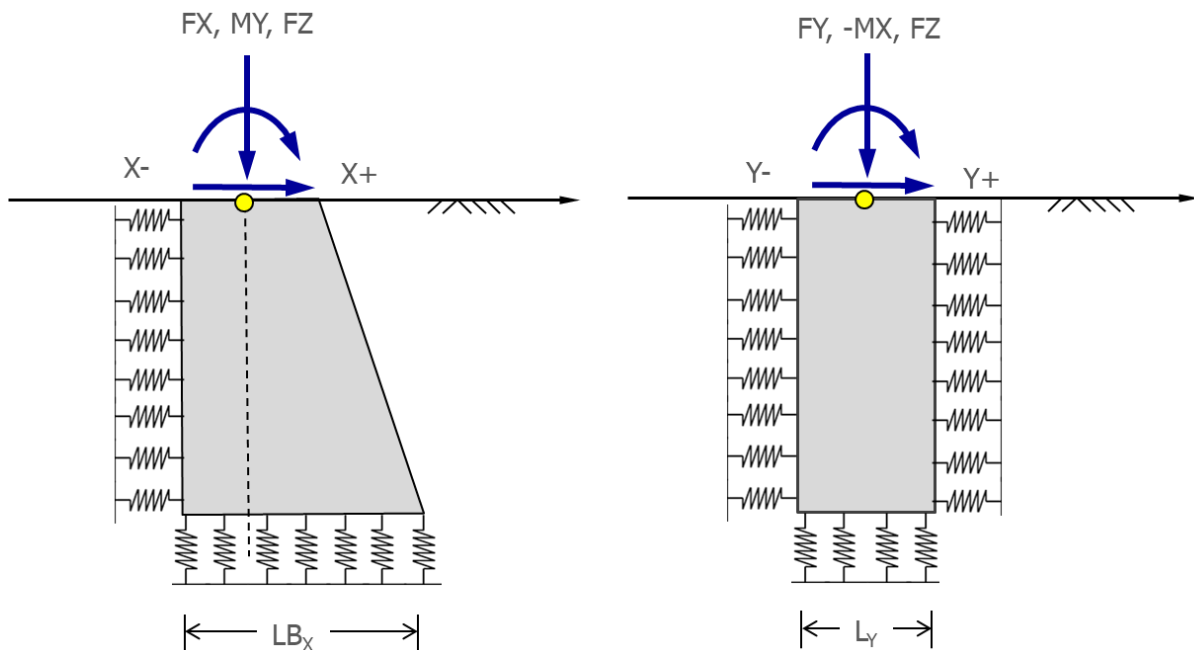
Principe du modèle de Winkler généralisé (multicouche, non-linéaire) – Fondation trapézoïdale
